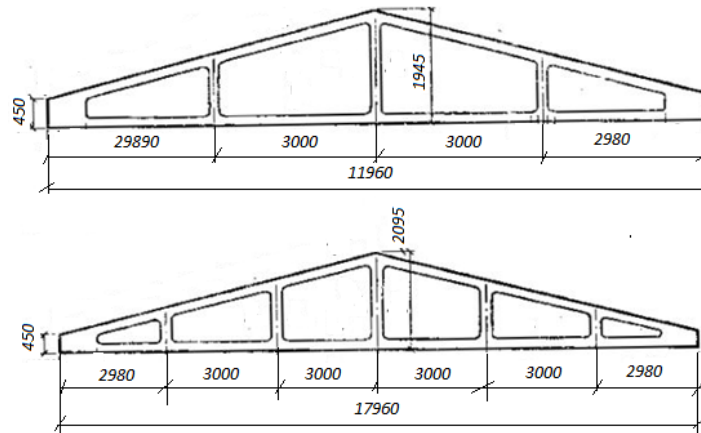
Сборные железобетонные безраскосные треугольные фермы пролетами 12 и 18 м
